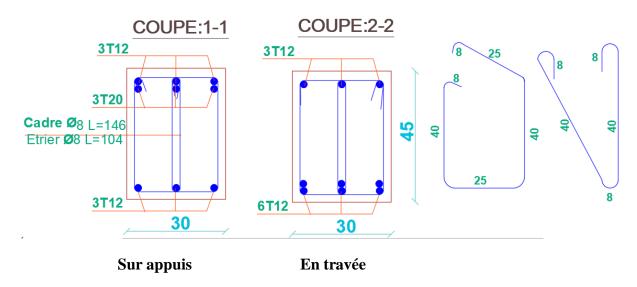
Ferraillage de la poutre principale  $(30 \times 45)$
